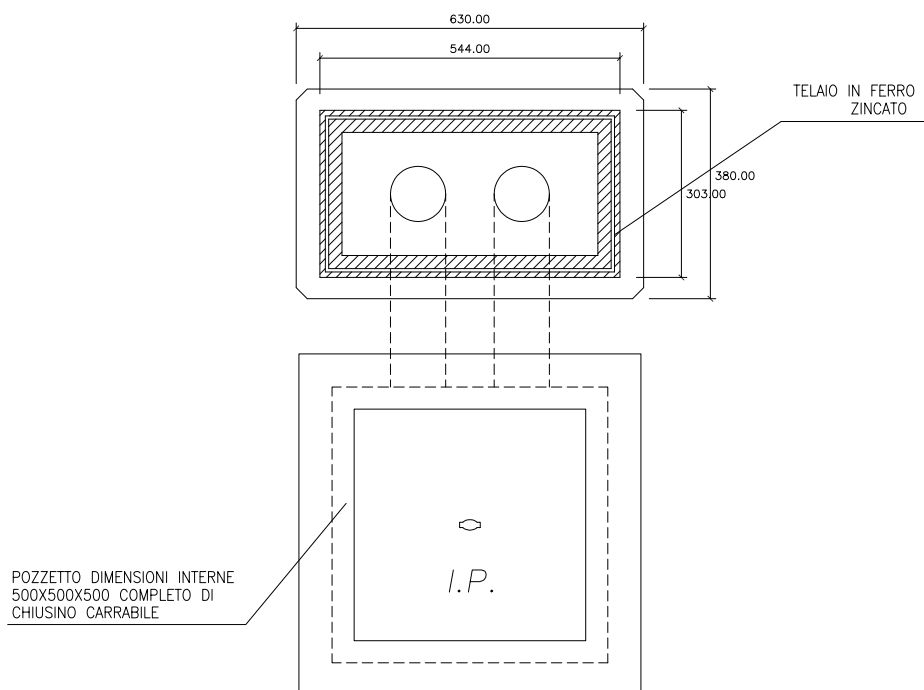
Sezione tipo plinto e pozzetto con collegamento di terra
